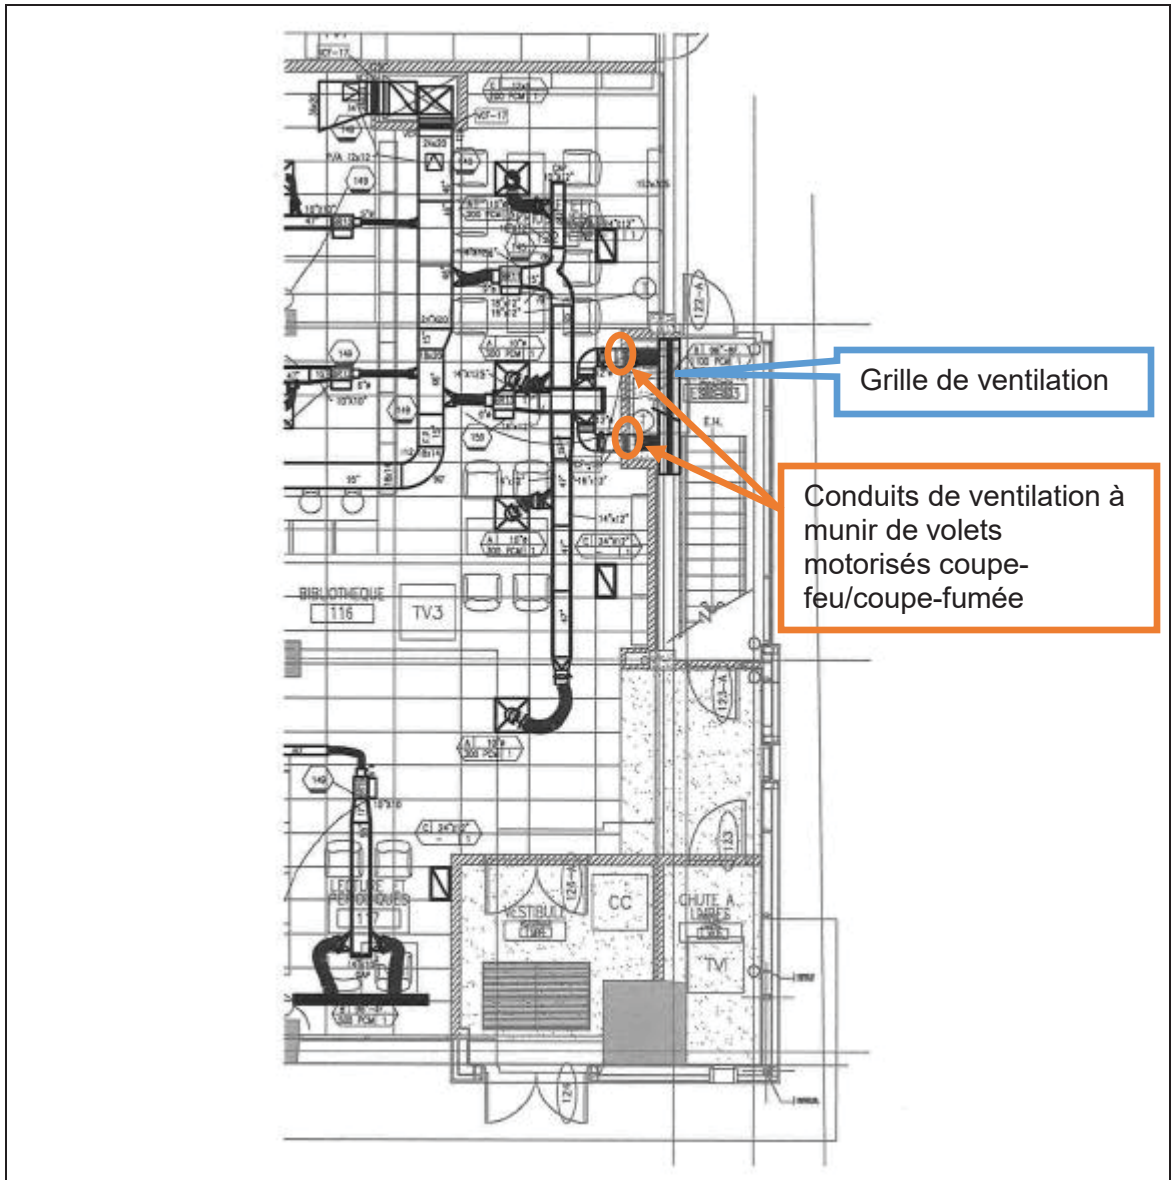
Plan partiel du rez-de-chaussée - Mécanique
